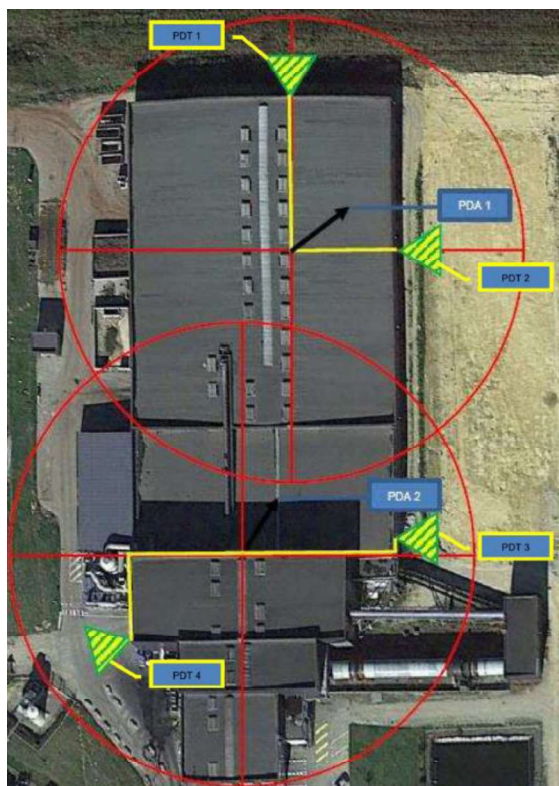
Plan d'implantation des paratonnerres (PDA) et des prises de terre (PDT) sur le bâtiment TMB
